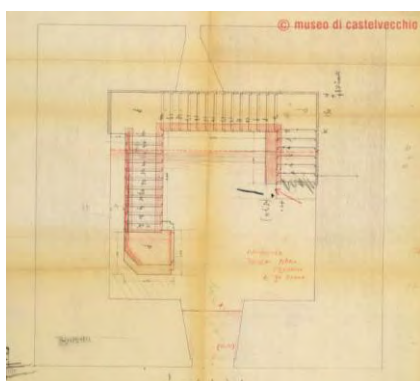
Pianta della scala tra il piano terra e il primo piano del Mastio.
